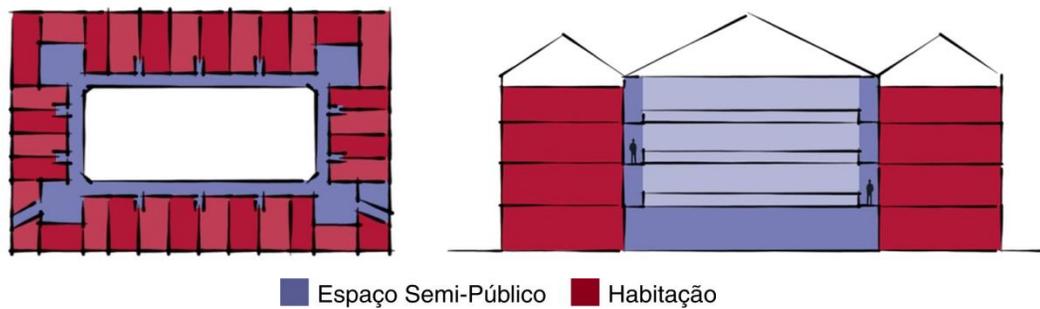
| Familistério - Detalhe em planta e corte do Pavilhão Central (Palácio Social) | Desenho Autora
